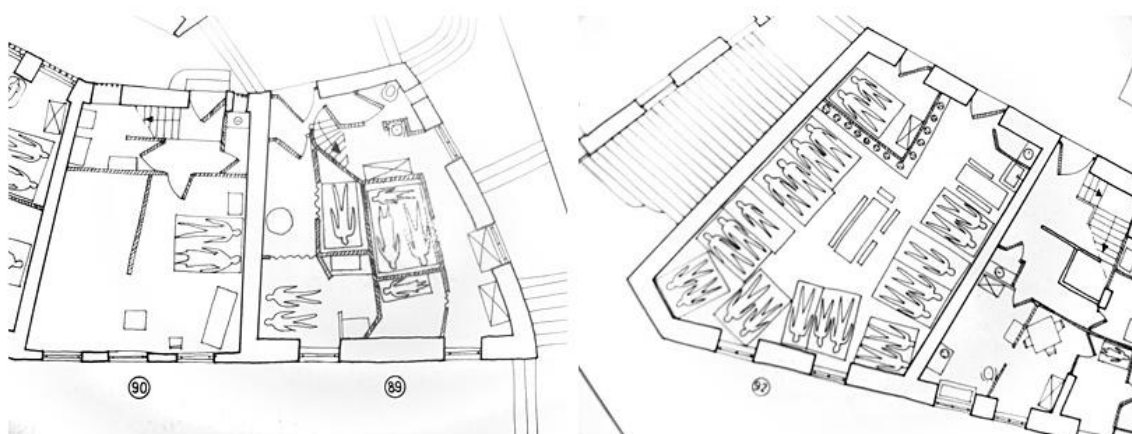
Excertos de uma planta que prova a sobrelotação do CHP.
